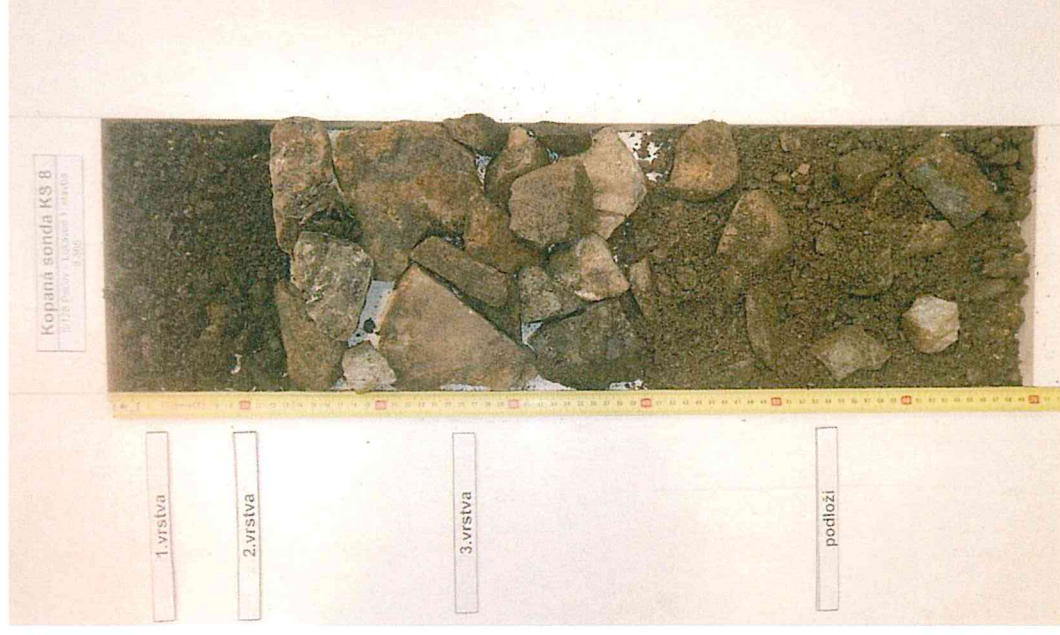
a č. 16 - Kopaná sonda KS 8
